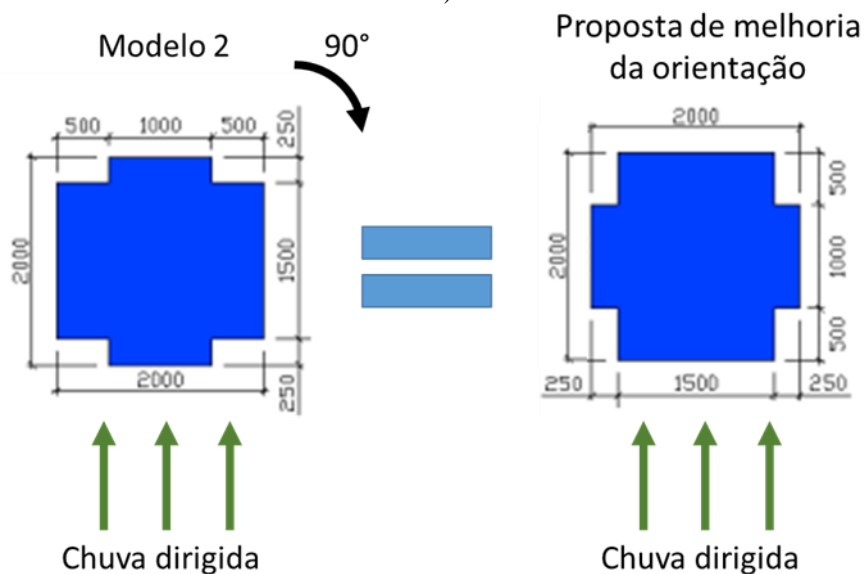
Primeira proposta de melhoria da estrutura de escoamento de fachadas
